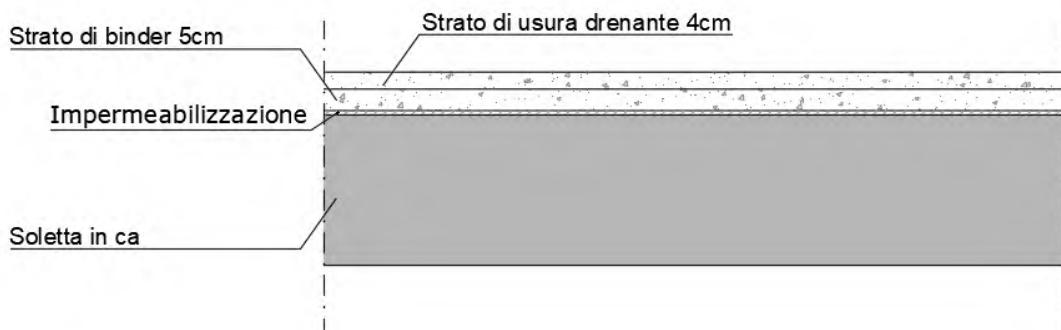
Composizione sovrastruttura autostrada e tangenziale su impalcato – TIPO P1C
